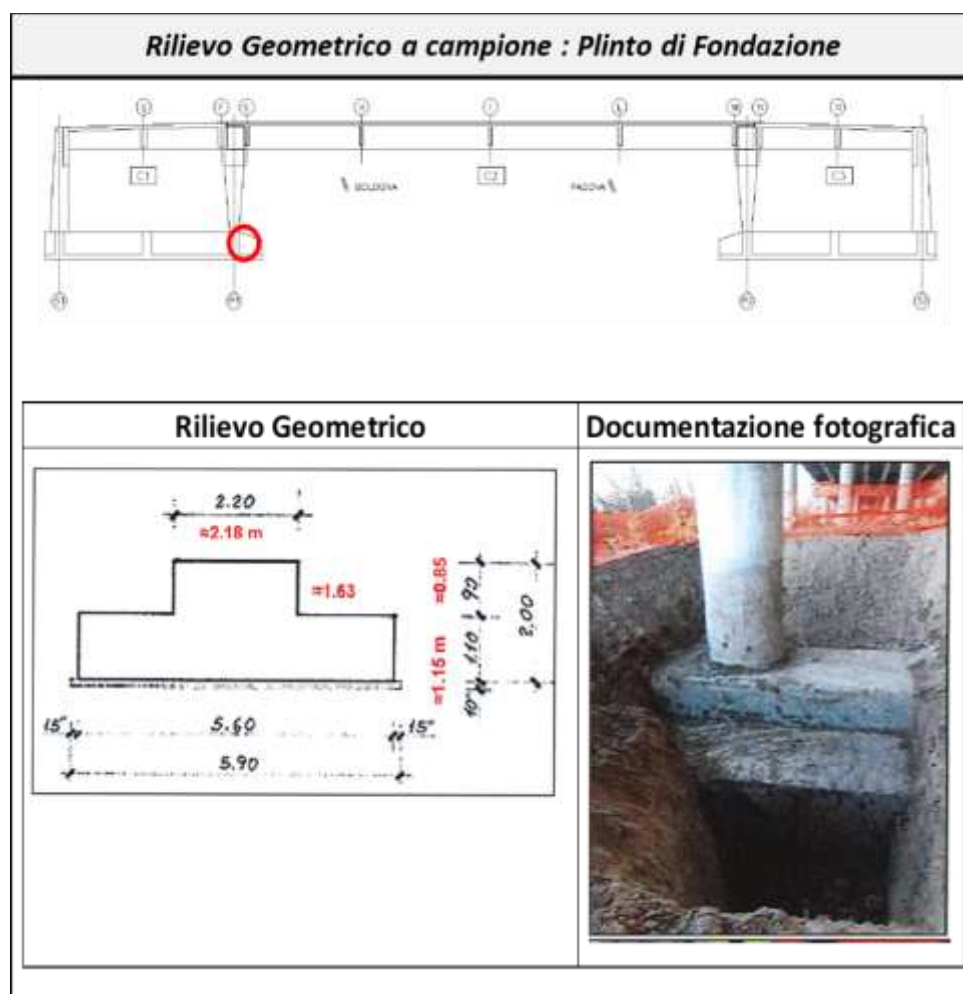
Esempio di restituzione- Rilievo Plinto di fondazione
